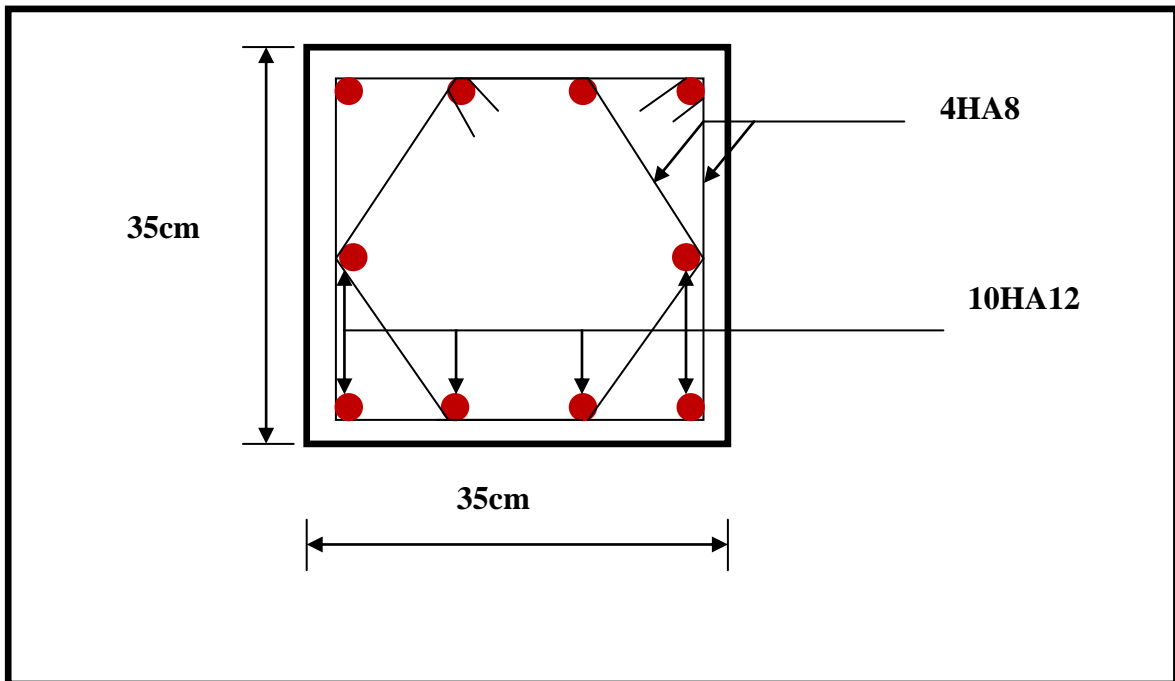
Ferrailage Poteau 35 × 35
